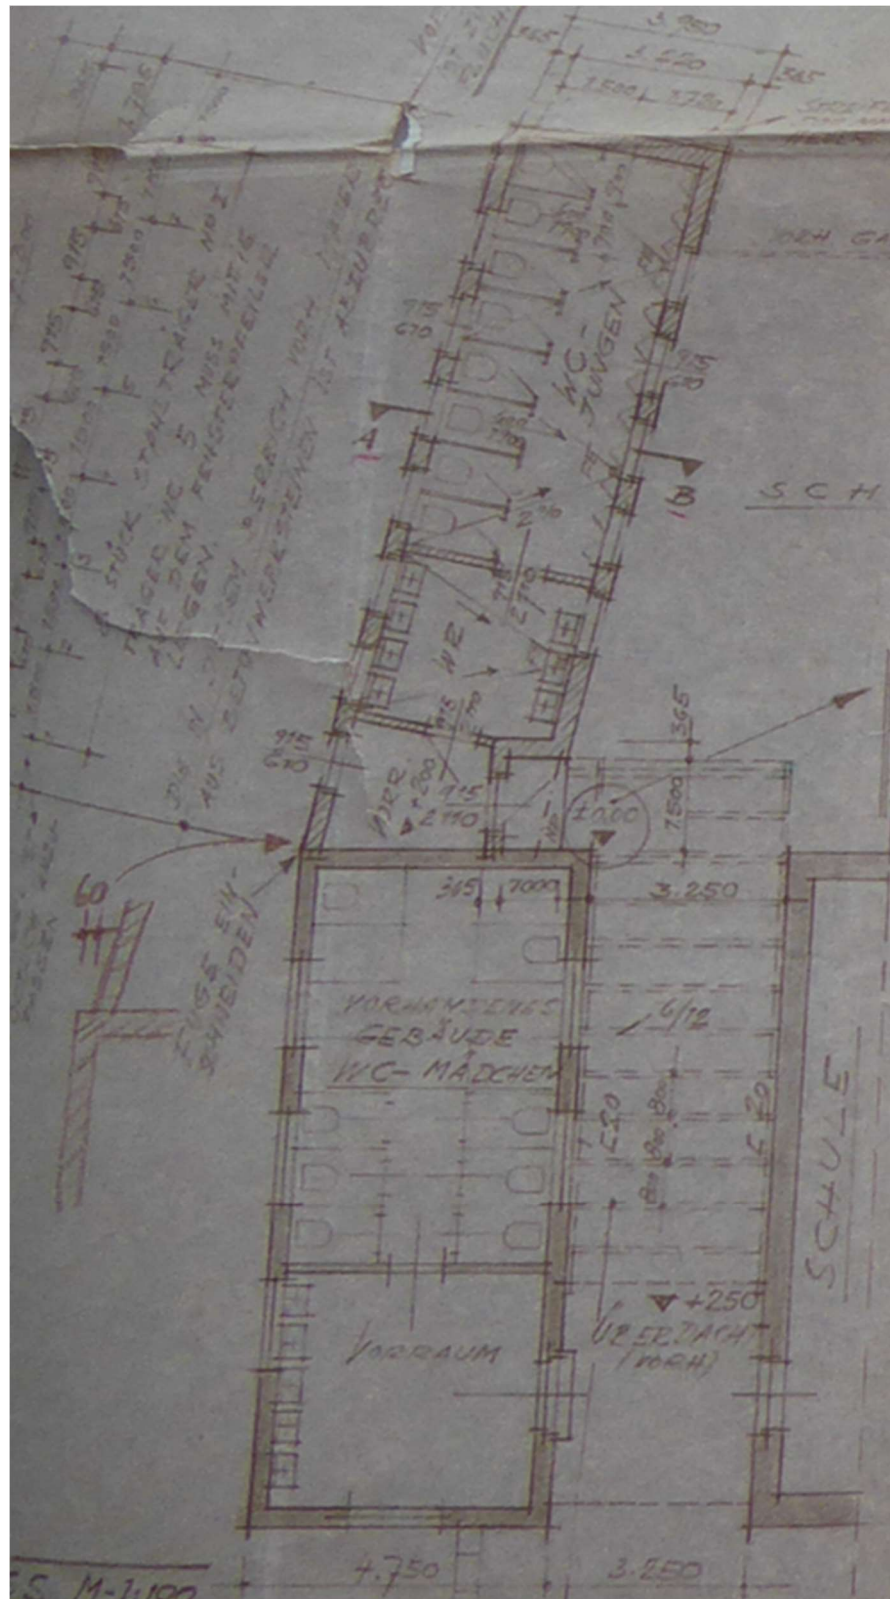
Grundriss mit ehem. Mädchen-WC (unten) und Neubau Jungen-WC (oben) [U1]
